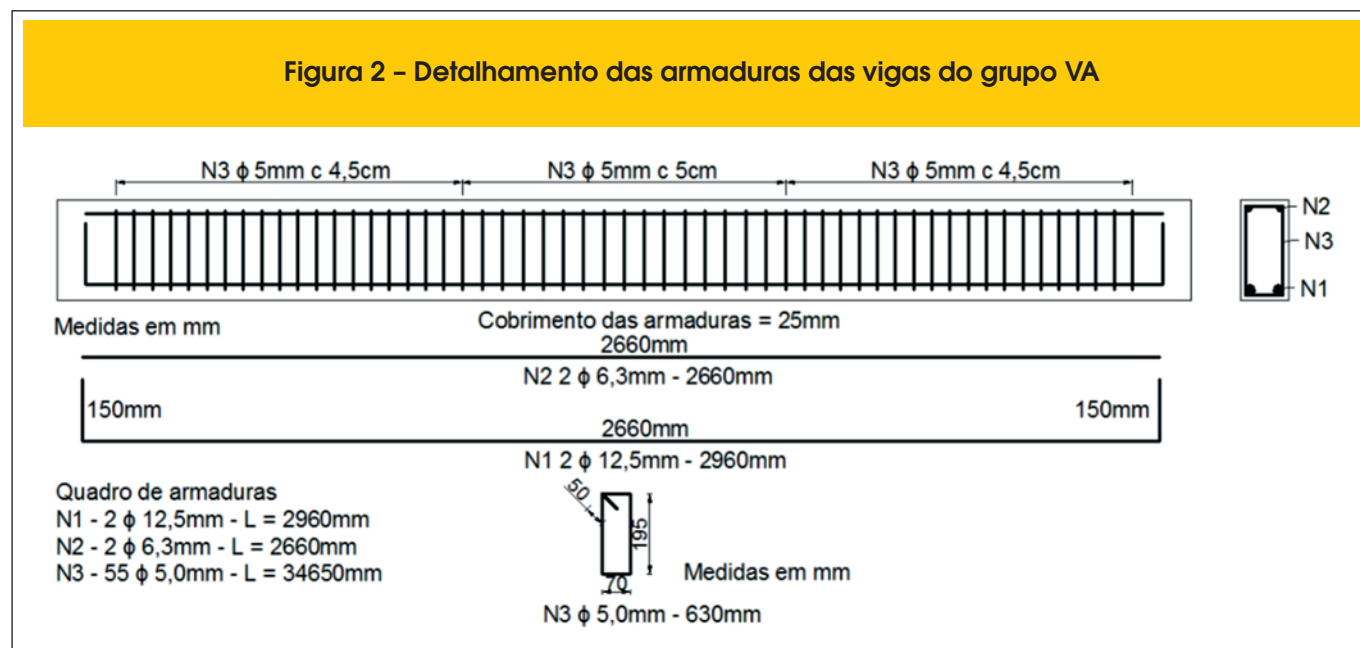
Detalhamento das armaduras das vigas do grupo VA
